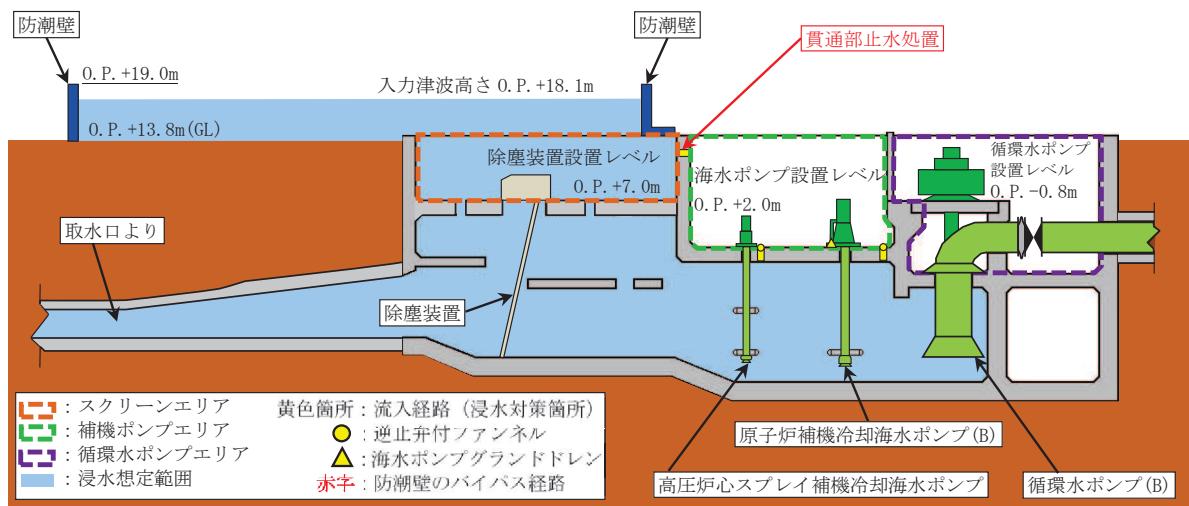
第 2 号機 海水ポンプ室 浸水対策配置図（A-A 断面図）
